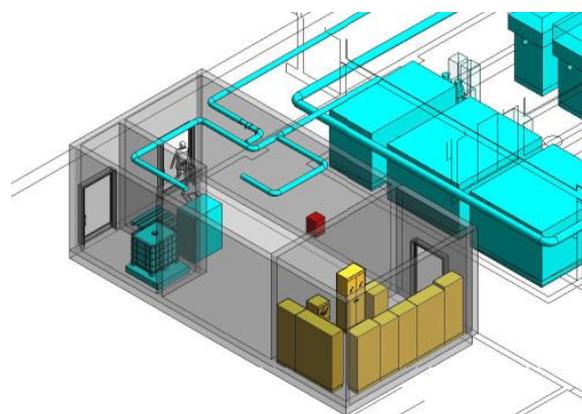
Mögliche Ansicht des Anbaus für die Technik
